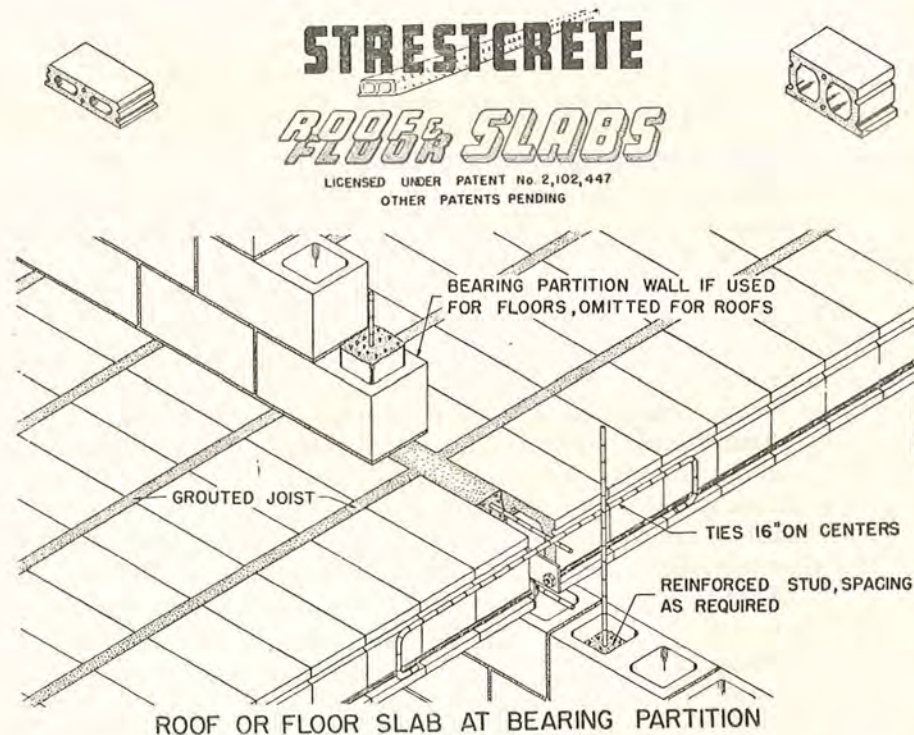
Eksempel på etageadskillelse af »Strestcrete« letbetonblokke, samlede med forspændt armering til monteringsfærdige bjælker.
